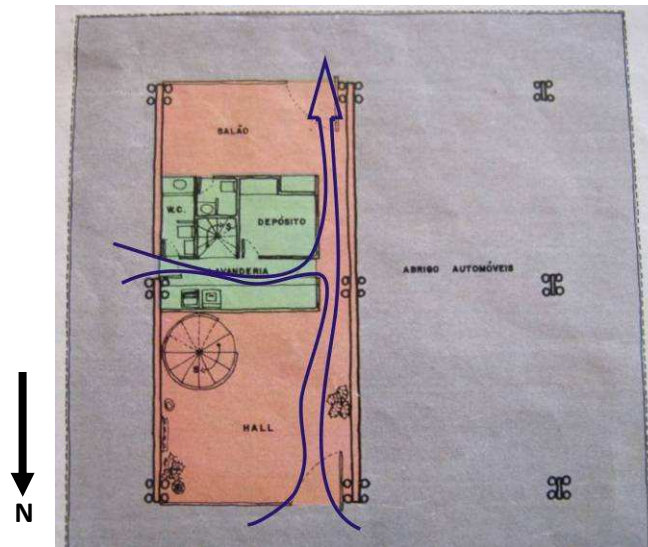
Residência Abrão Assad: planta esquemática do pavimento térreo.
